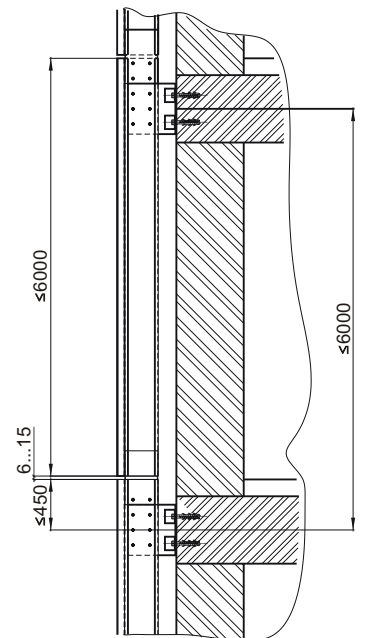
Принципиальная схема установки кронштейнов КР на стене по вертикали (крепление кронштейнов к плитам перекрытия)
